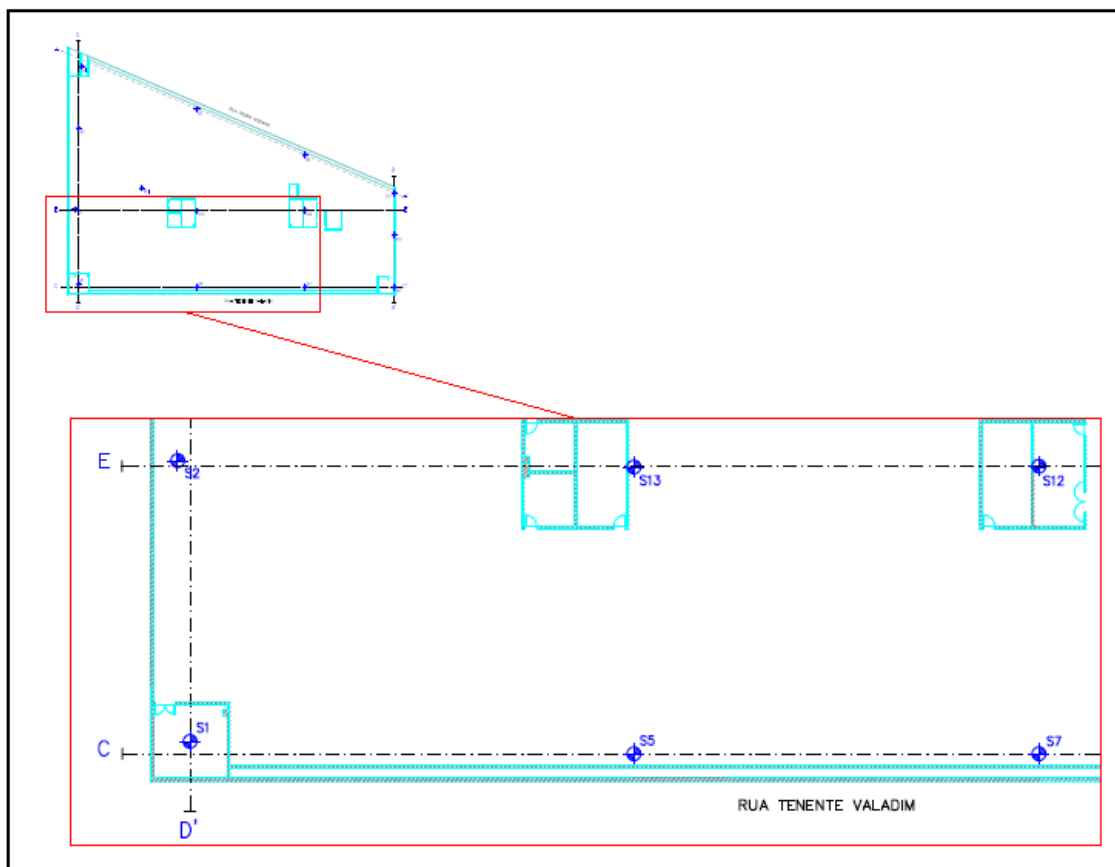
Planta de sondagens, com pormenor da zona de interesse.
